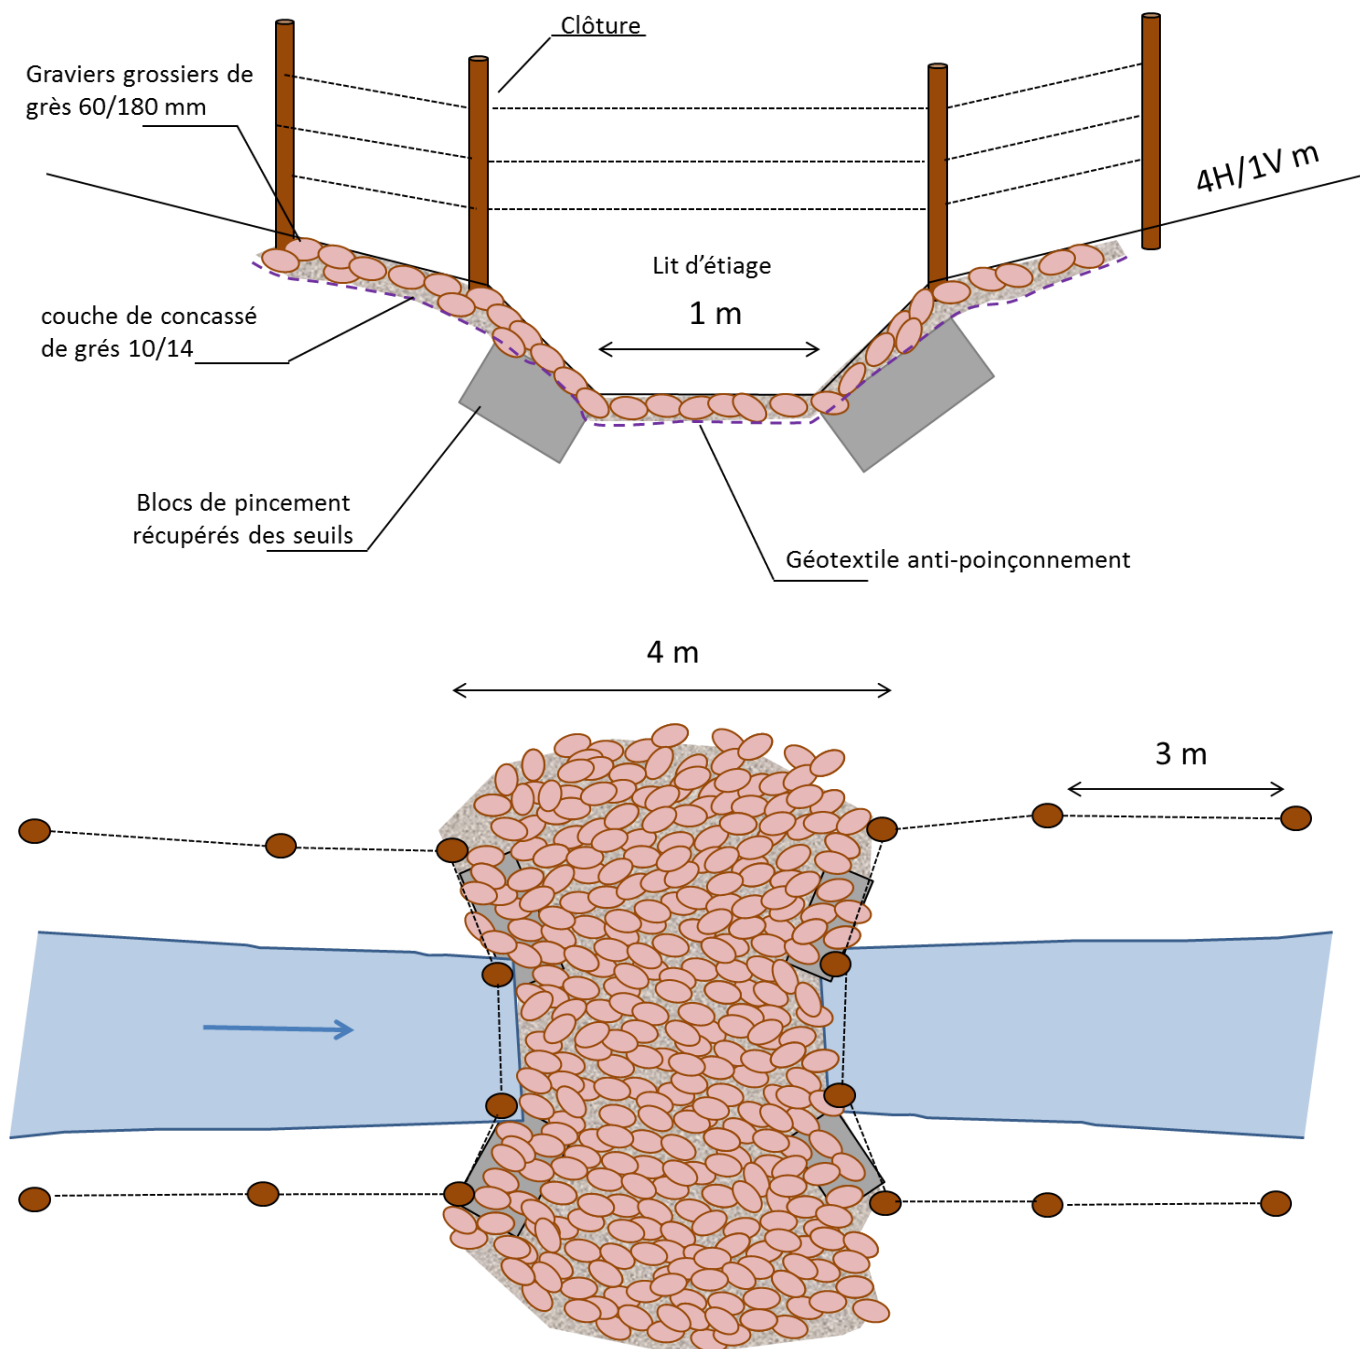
Vue en coupe et plan de principe d'aménagement du passage à gué
